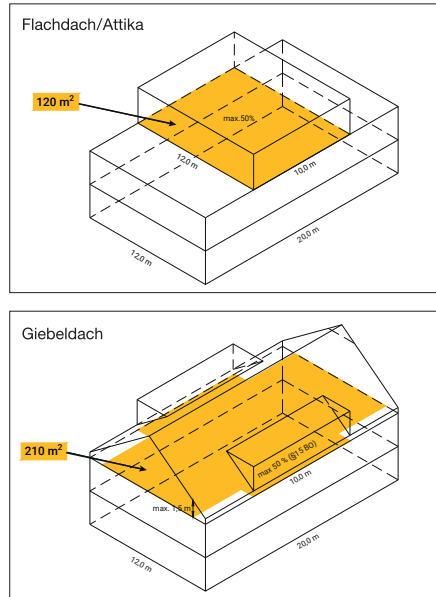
Erläuterungsskizze neue Messweise Attikageschoss und Dachgeschoss
